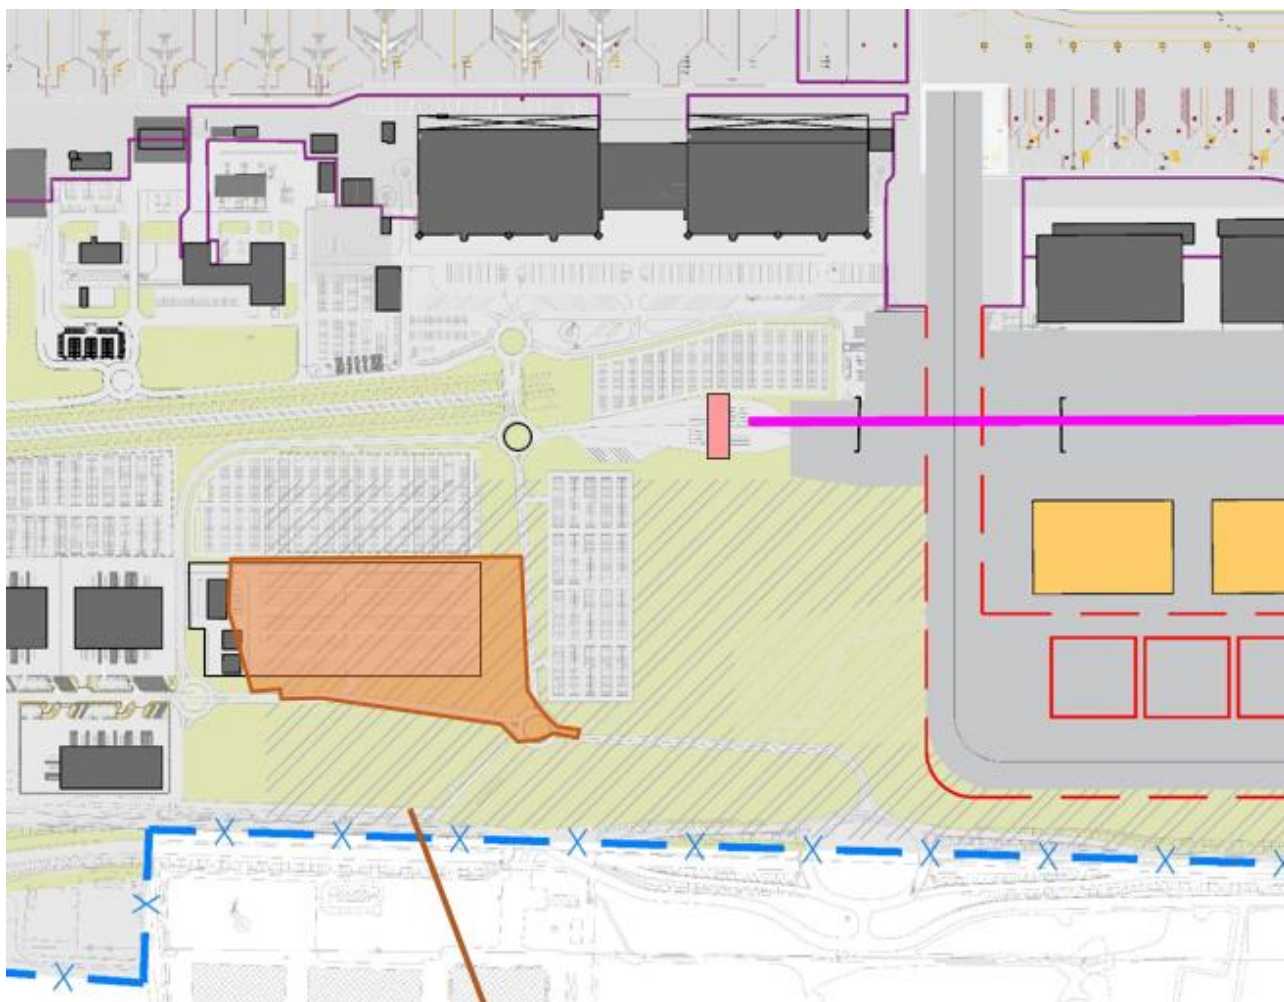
Sovrapposizione Pass4core Alternativa 2 - Accessibilità
